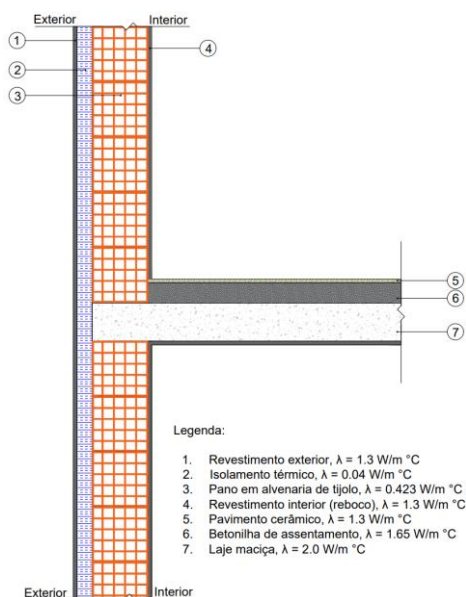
Pormenor construtivo da ligação entre fachada e pavimento intermédio com isolamento contínuo pelo exterior.
